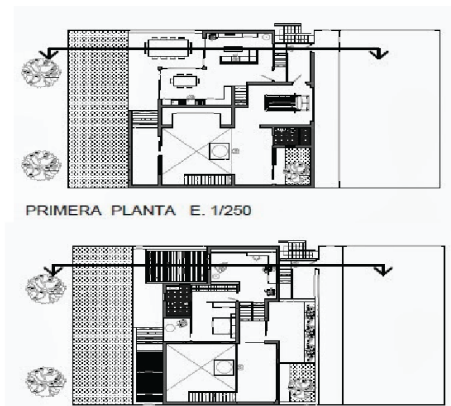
Jorge Pablos Ponce, Corte de sección y Plantas (2013) Fuente: <http://jorgep93.blogspot.com/10/2013/corte-de-seccion-de-alzado-y-plantas.html>
